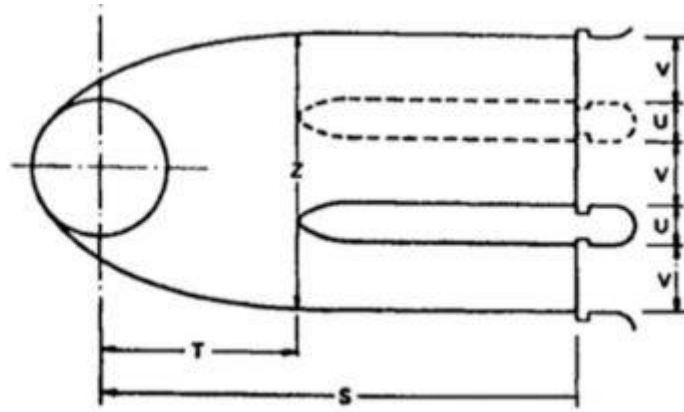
Parámetros en planta un tubo de aspiración con codo para una turbina Kaplan. [6]
